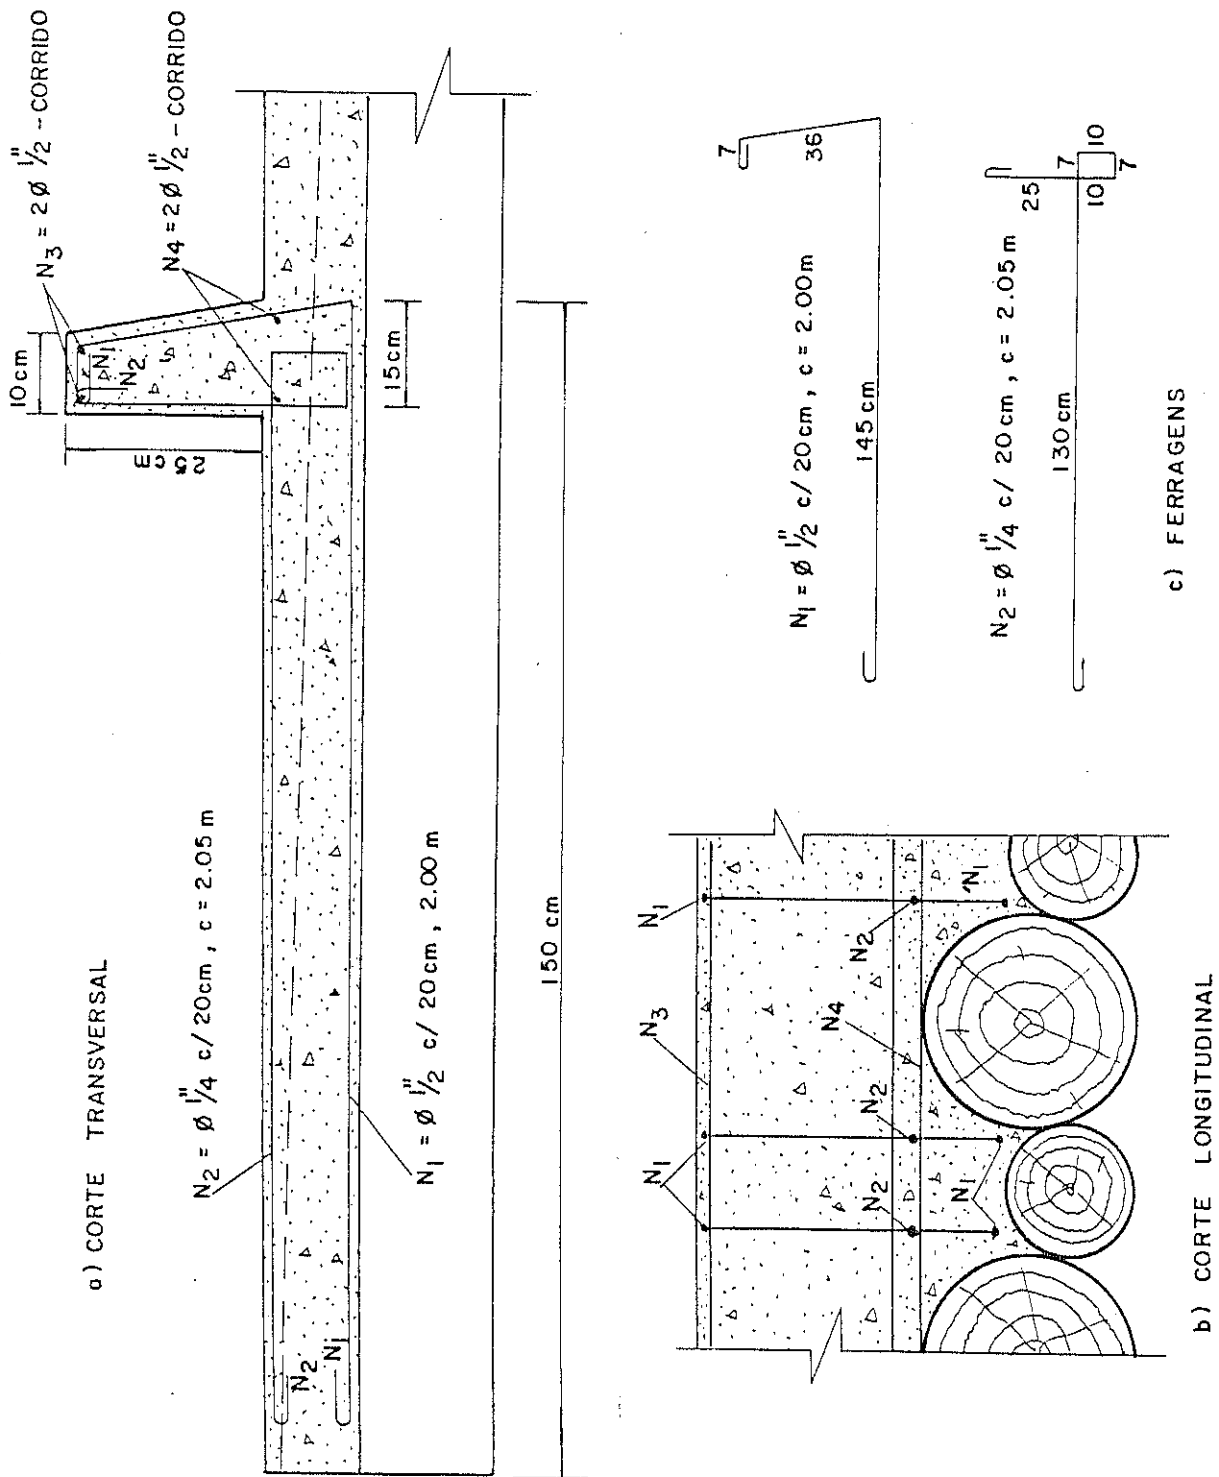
O GUARDA - RODAS , DIMENSÕES E FERRAGENS
